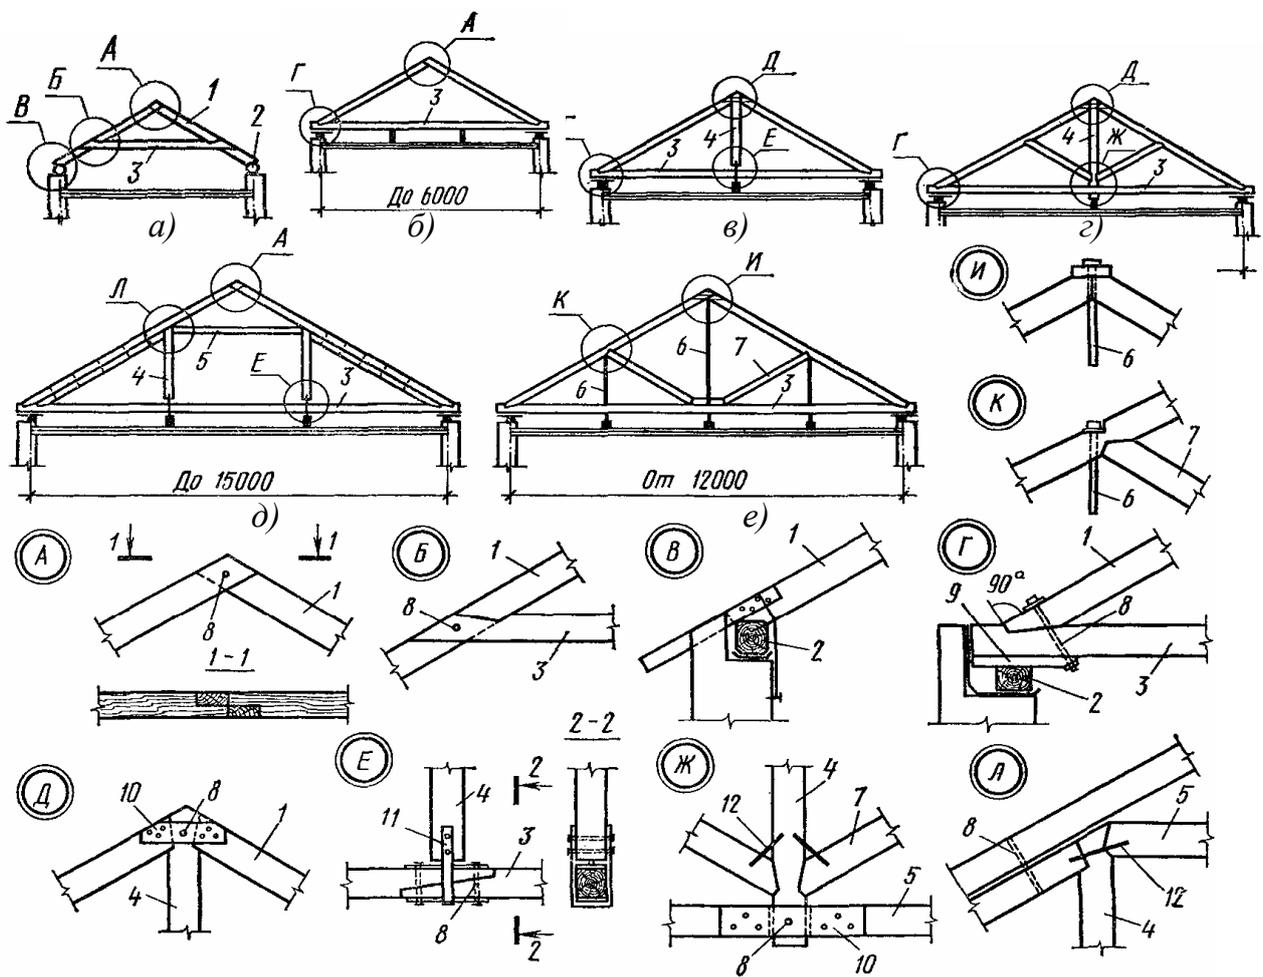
Висячие стропила (стропильные фермы): а – с поднятой затяжкой; б – с затяжкой, используемой для подвески чердачного перекрытия; в – с подвесной бабкой; г – с подвесной бабкой и подкосами; д – с двумя подвесными бабками; е – металло-деревянная ферма; 1 – стропильная нога; 2 – мауэрлат; 3 – затяжка; 4 – подвесная бабка; 5 – распорка; 6 – стальная стойка фермы; 7 – подкос; 8 – болт; 9 – коротыш; 10 – деревянная накладка; 11 – хомут; 12 – скоба
